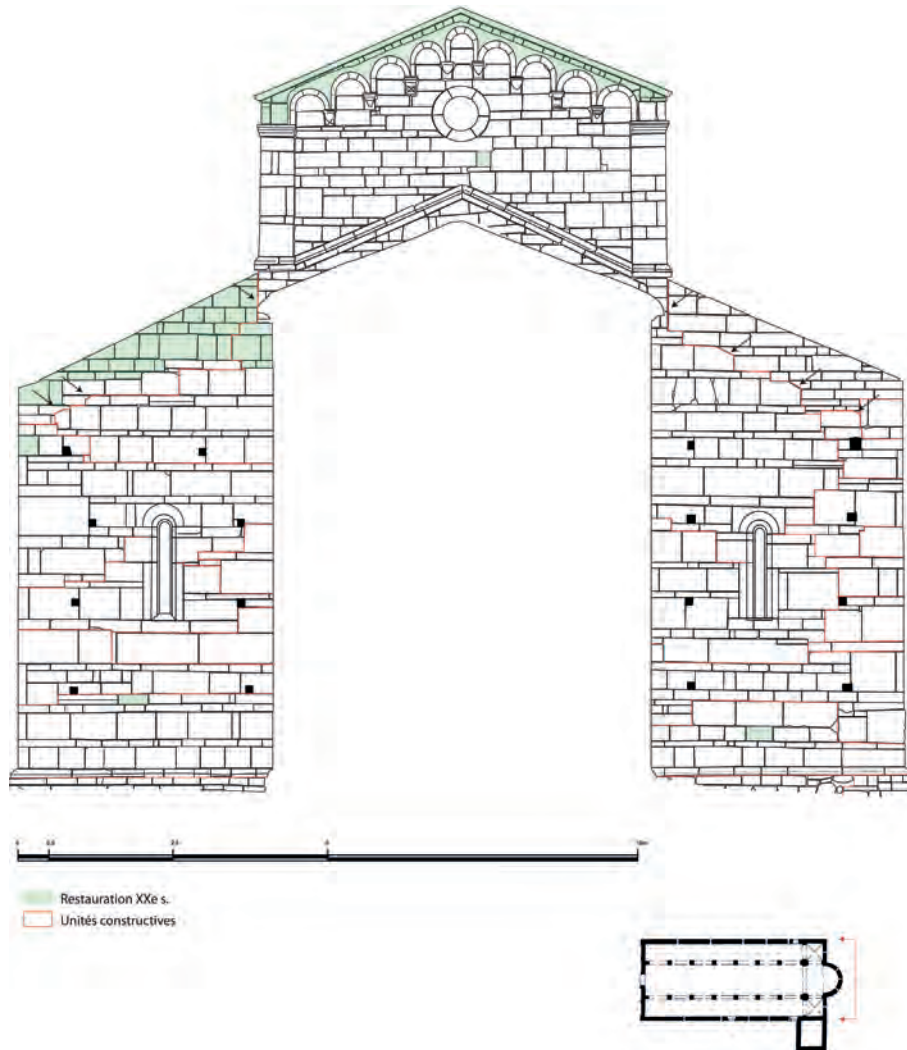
Relevé pierre-à-pierre de la façade orientale (extérieure).
